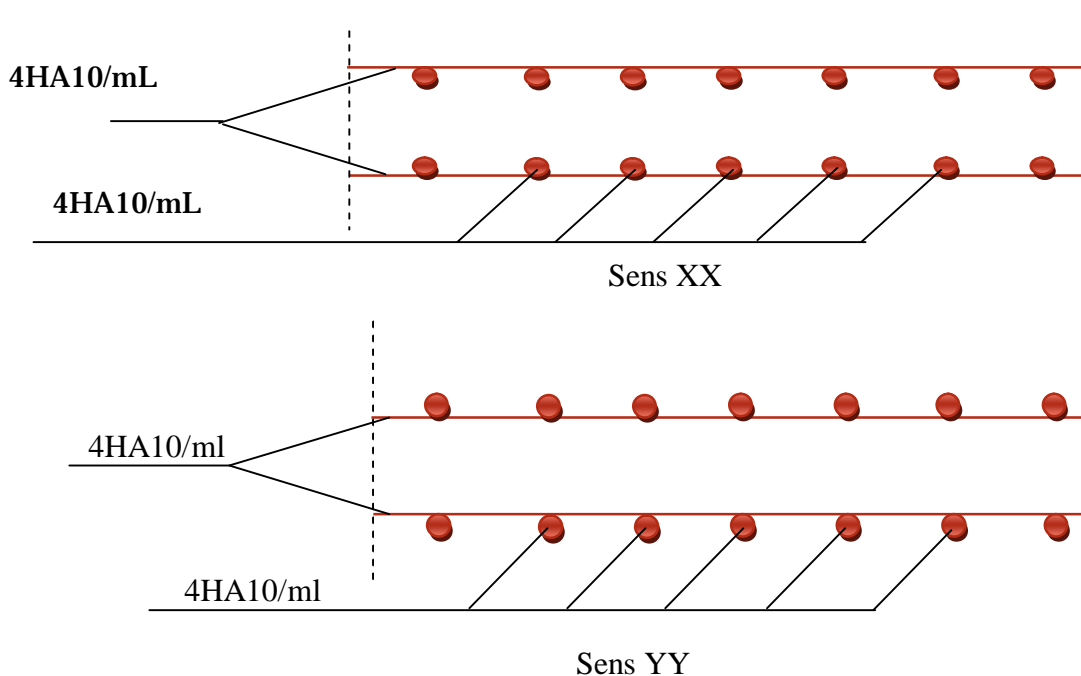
Plan de ferrailage de la dalle pleine (salle machine).
